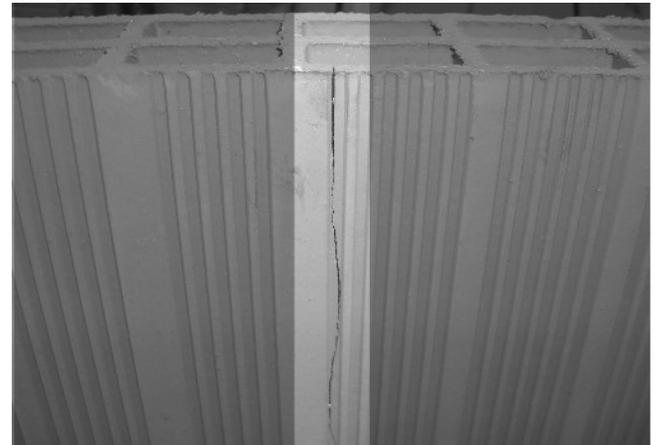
Detalle de fisuras presentes en las posiciones A y B.
